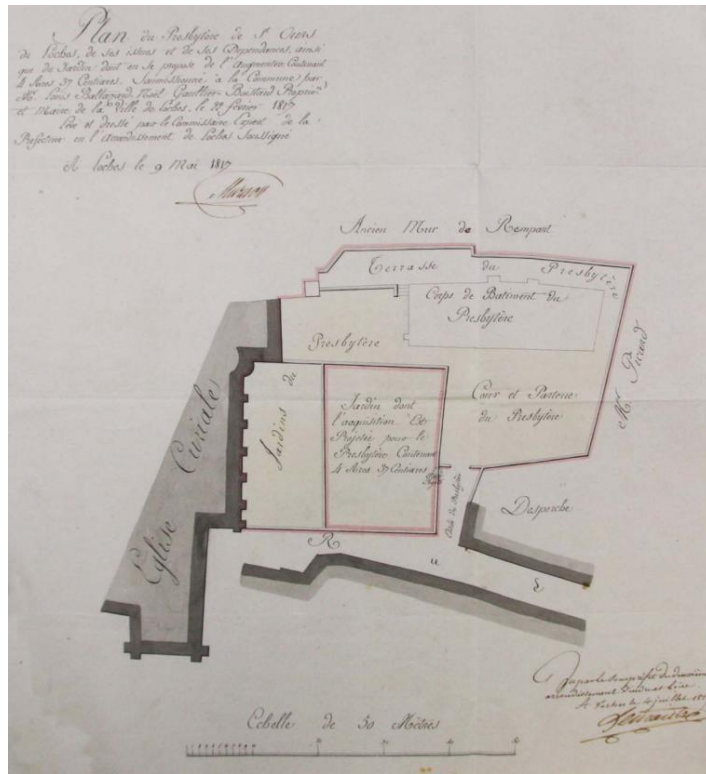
Plan du presbytère Saint-Ours par Pierre Murison, 9 mai 1817 (ADIL, 2 O 132-18 - cliché S. Bourocher).
